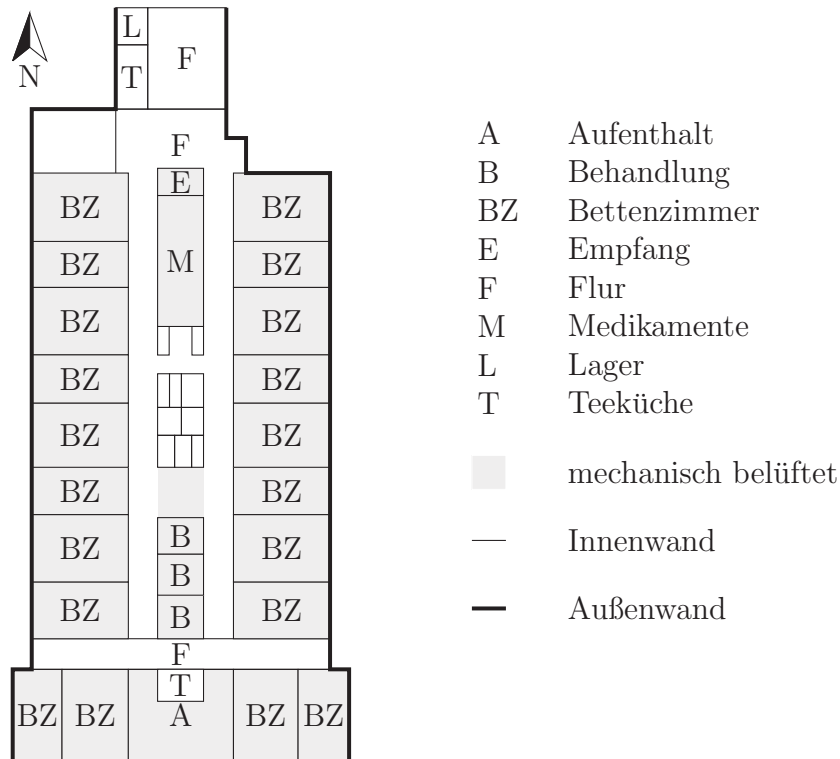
Grundriss einer Pflegestation des Wahlleistungsgebäudes
